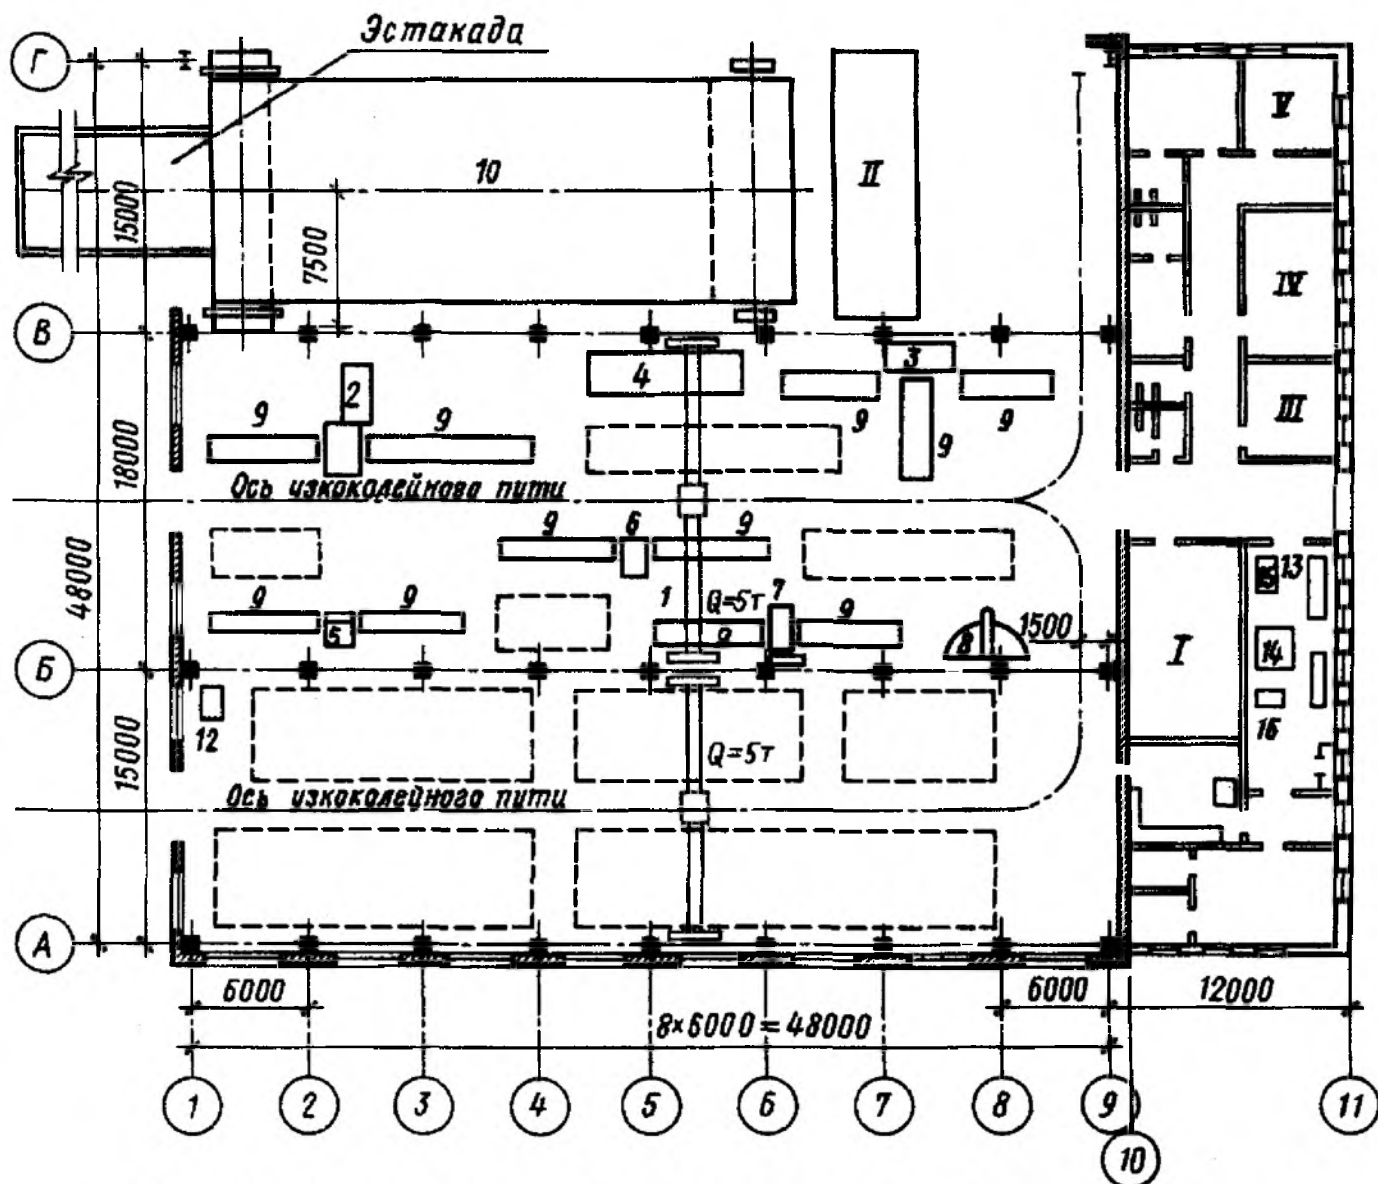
План расстановки оборудования цеха резервуарных конструкций
